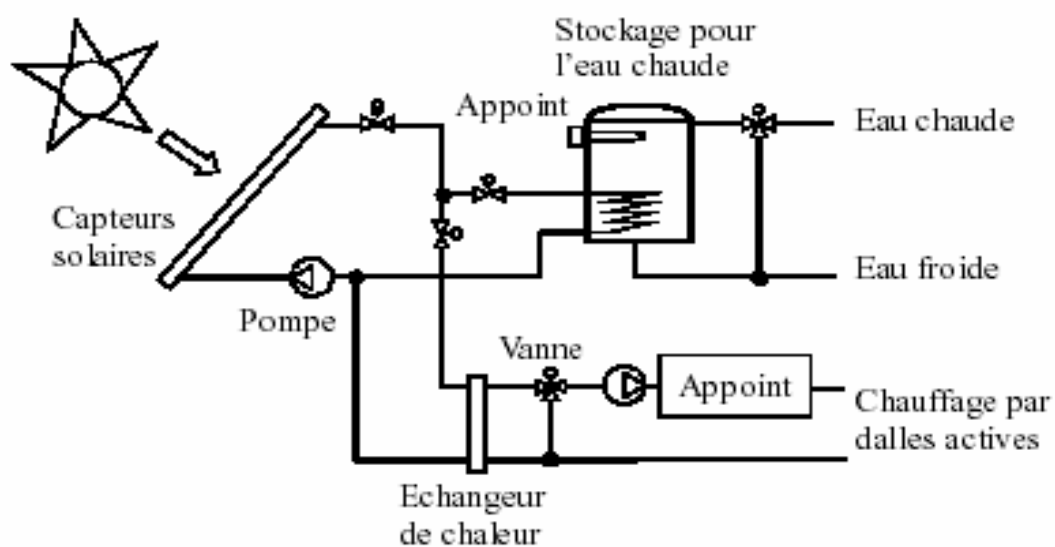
Schéma de principe simplifié de l'installation solaire active couplée aux dalles actives
